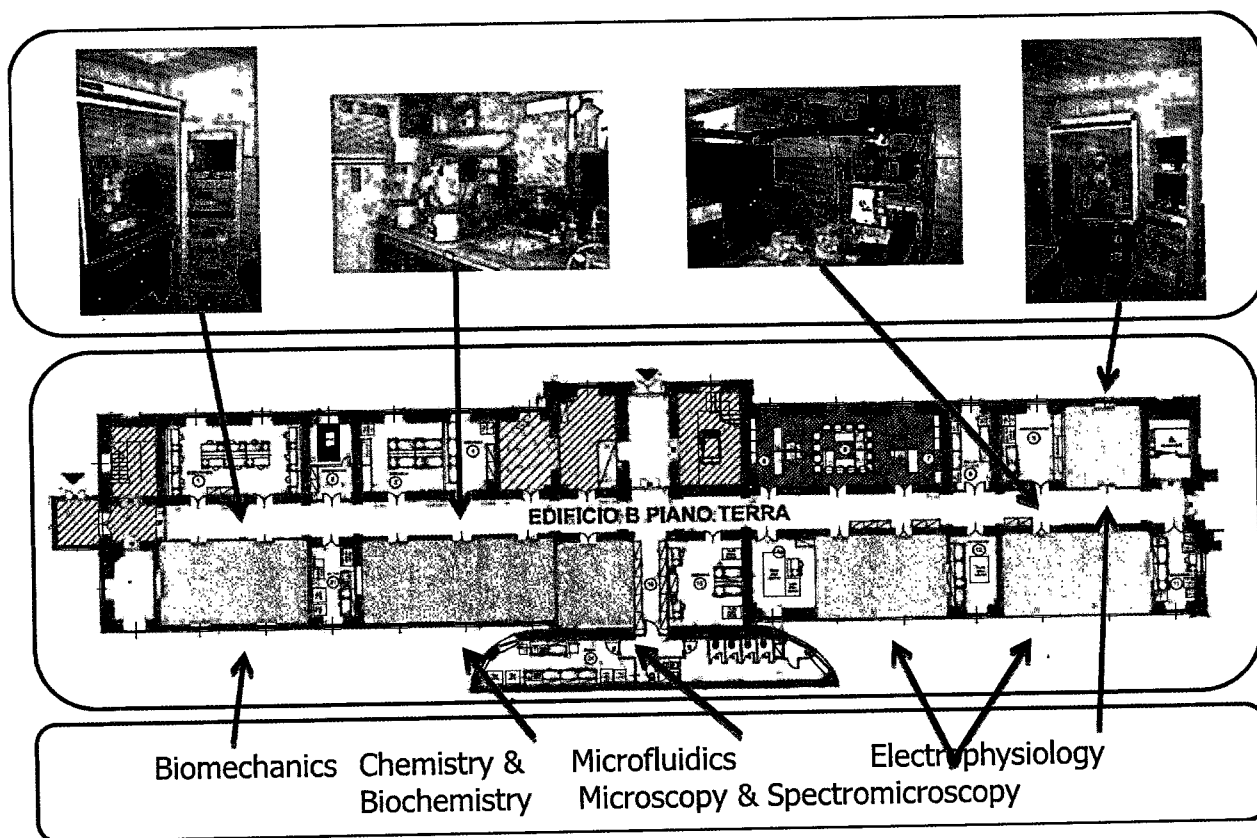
Planimetria del piano terra (palazzina B) e dislocazione dei laboratori di ricerca
